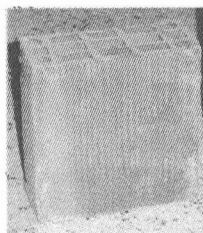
鉄筋コンクリート造建築物と穴明きれんが
